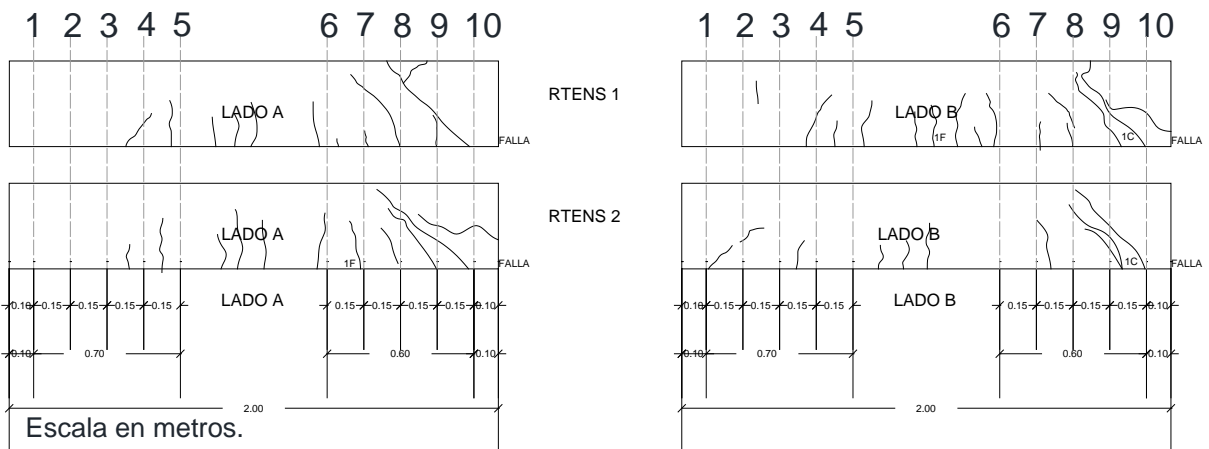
Patrón de agrietamiento en ambas caras de las vigas de control RTENS ensayadas a flexión.
